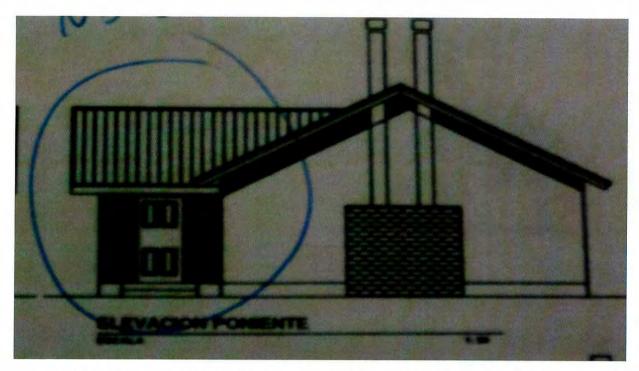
Fachada poniente con puerta de acceso plano de proyecto.
